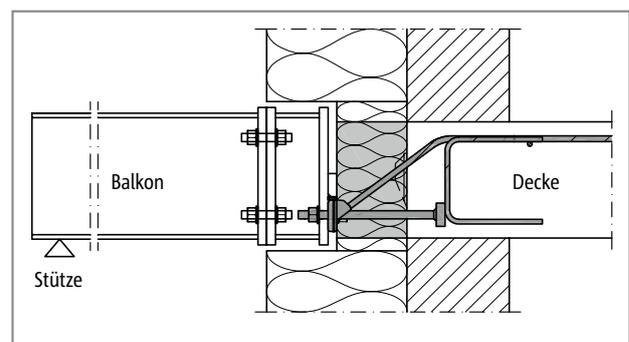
Schöck Isokorb® XT Typ SQ: Anschluss des Stahlträgers an einen Adapter, der die Dicke der Außendämmung ausgleicht
